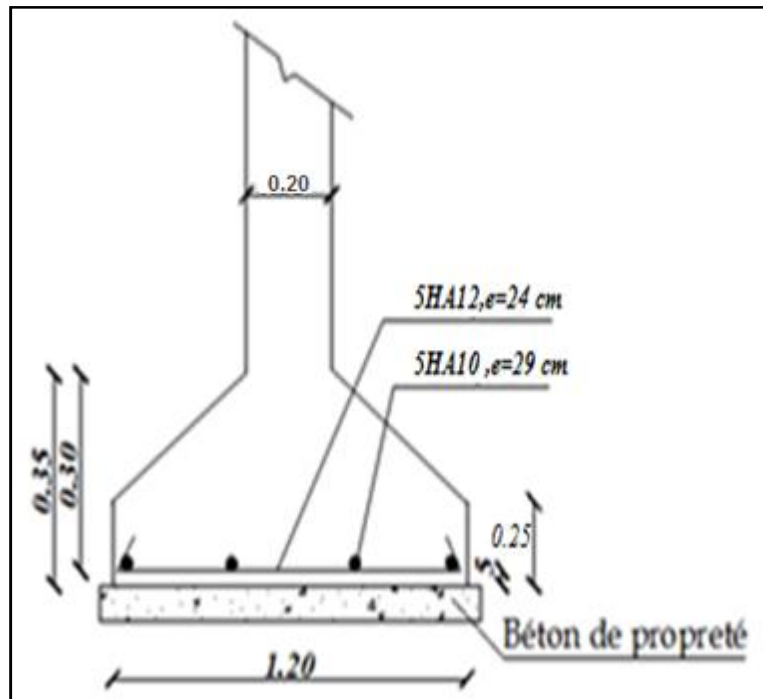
Exemple de ferrailage d'une semelle filante sous voiles
